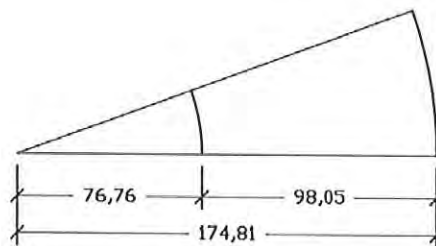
Future Design 1 – Grundriss und rotationssymmetrisches Ersatzmodell
